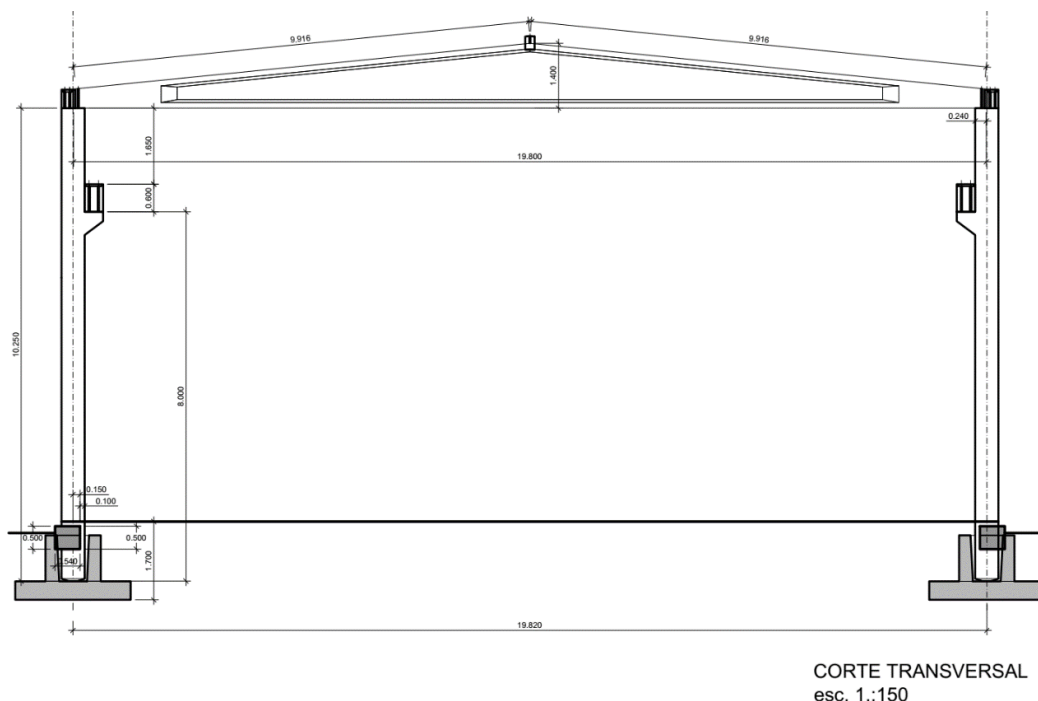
Secção transversal do pórtico do pavilhão industrial.
